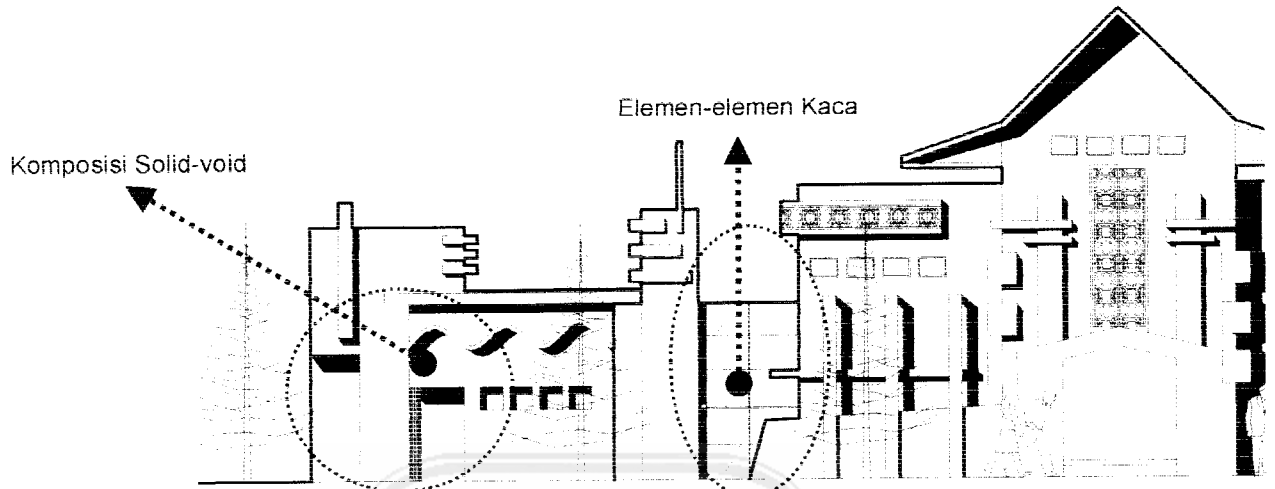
Penerapan simbol dan ornamen pada fasade bangunan
